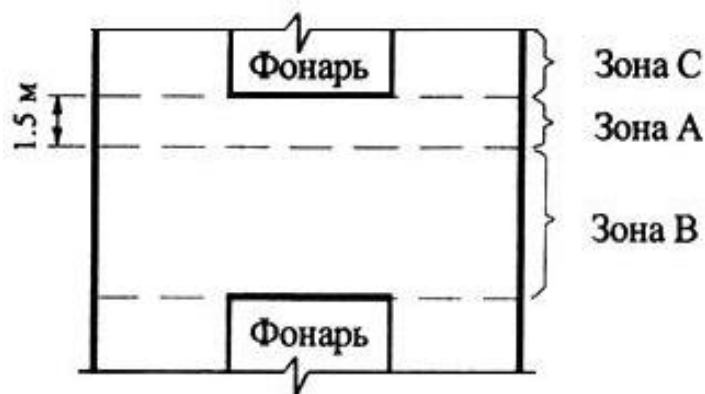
Схема здания с продольными фонарями к расчету снеговой нагрузки
